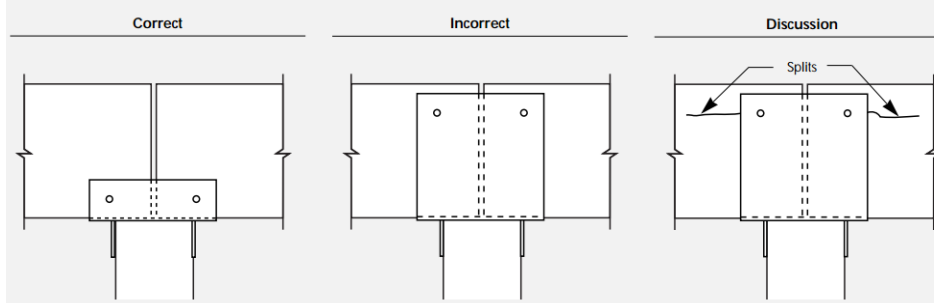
(Continuação da página anterior) - Outros detalhes para a integridade construtiva aplicáveis principalmente aos sistemas portcados (APA - The Engineered Wood Association, 1999).
